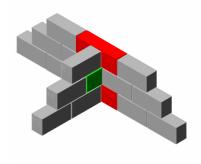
Amarração em "T" (fonte: INTERESTRUTURAS)
